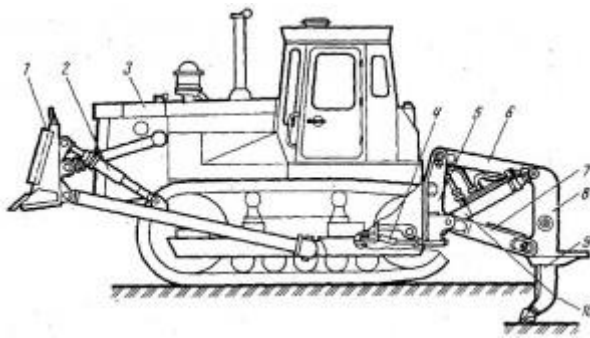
Бульдозернорыхлительный агрегат: 1 — отвал; 2 — гидрораскос; 3 — трактор; 4 — прицепная серьга; 5 — опорная рама; 6 — верхняя тяга; 7 — рама; 8 — рабочая балка; 9 — зуб; 10 — гидроцилиндр.
